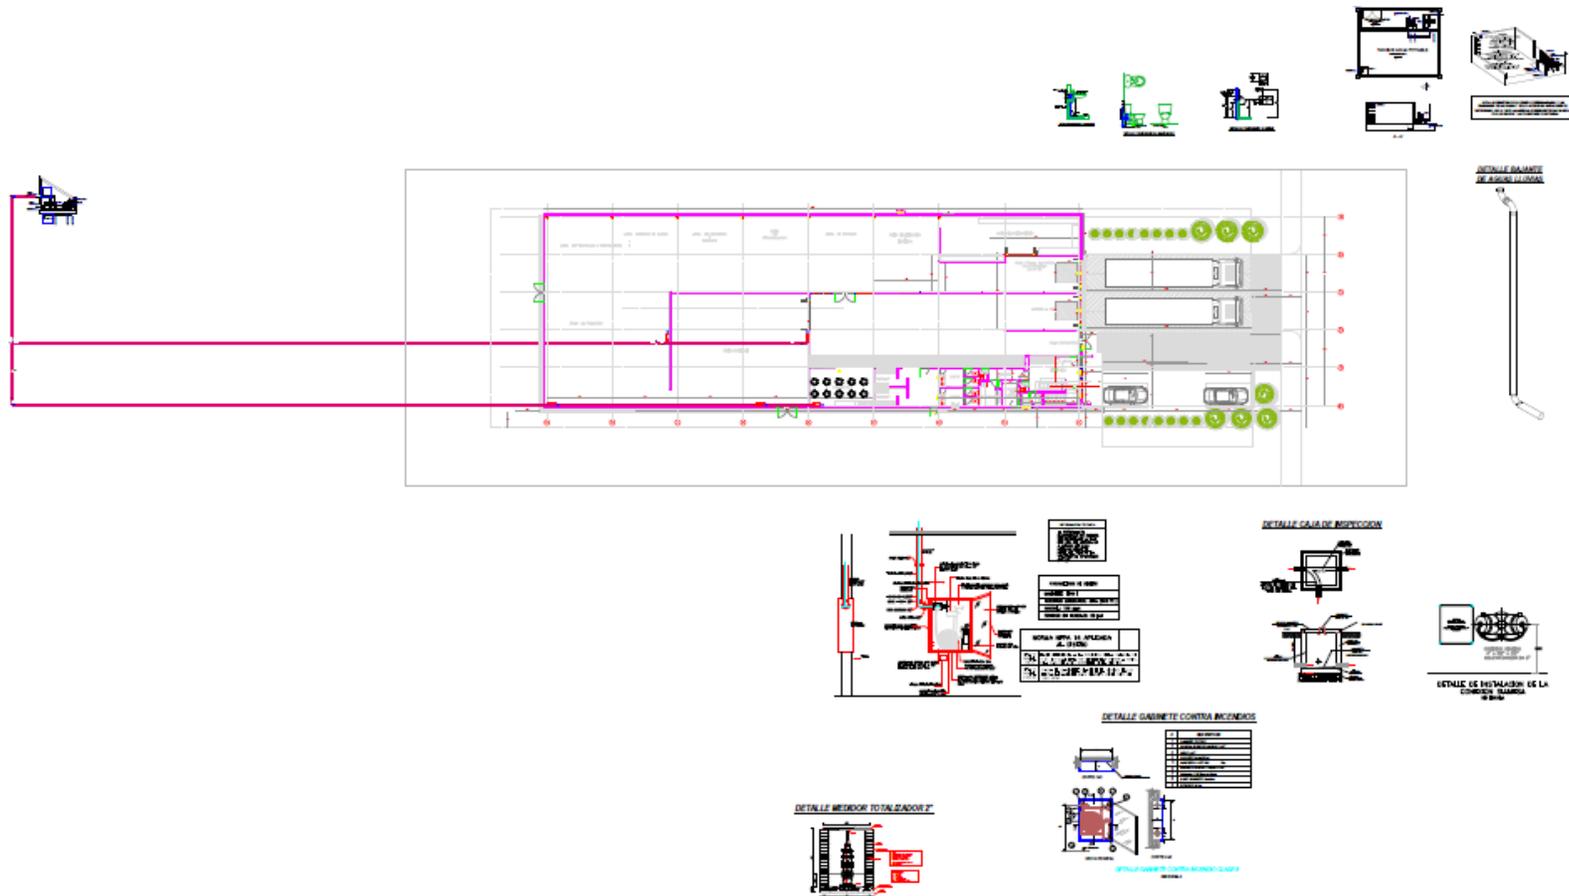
Planta, Alzada Cribado y Detalles Constructivos
